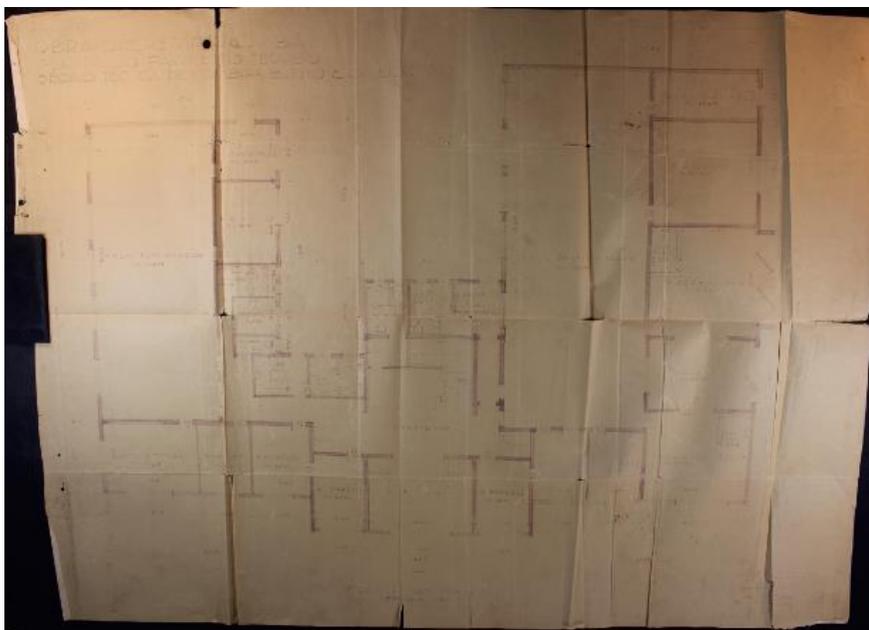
Planta do primeiro pavimento da Secretaria Geral.
